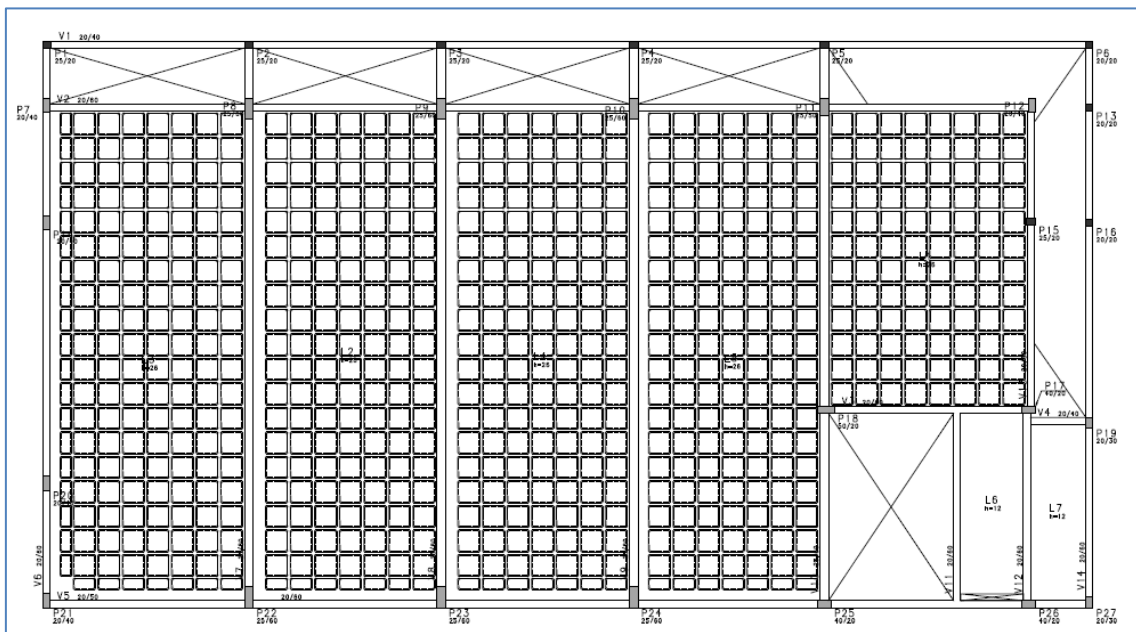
Planta de fôrma: subsolo, concreto protendido (CAD/TQS)
